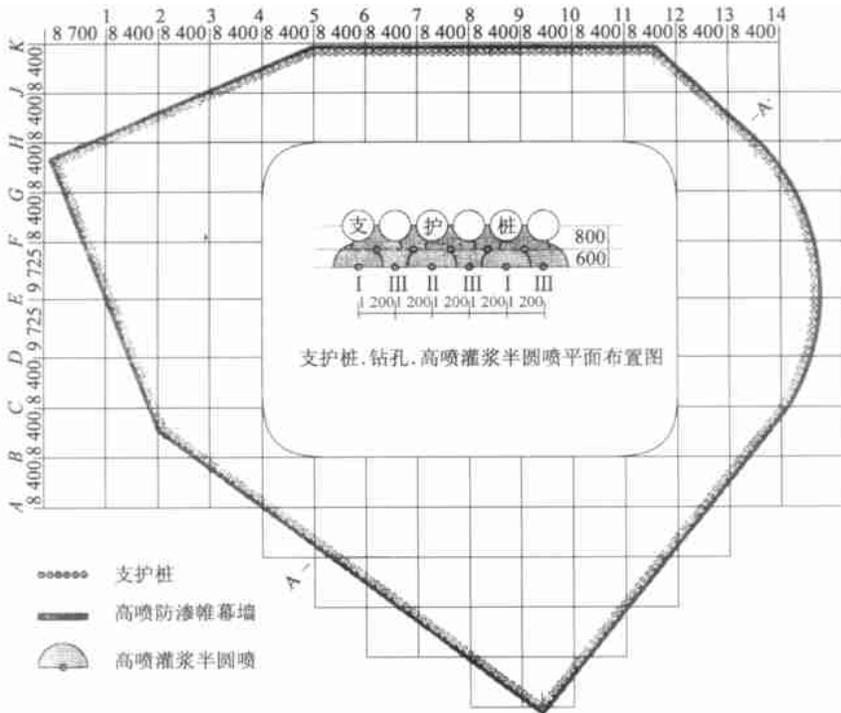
建银大厦基坑支护高喷防渗帷幕平面示意图
